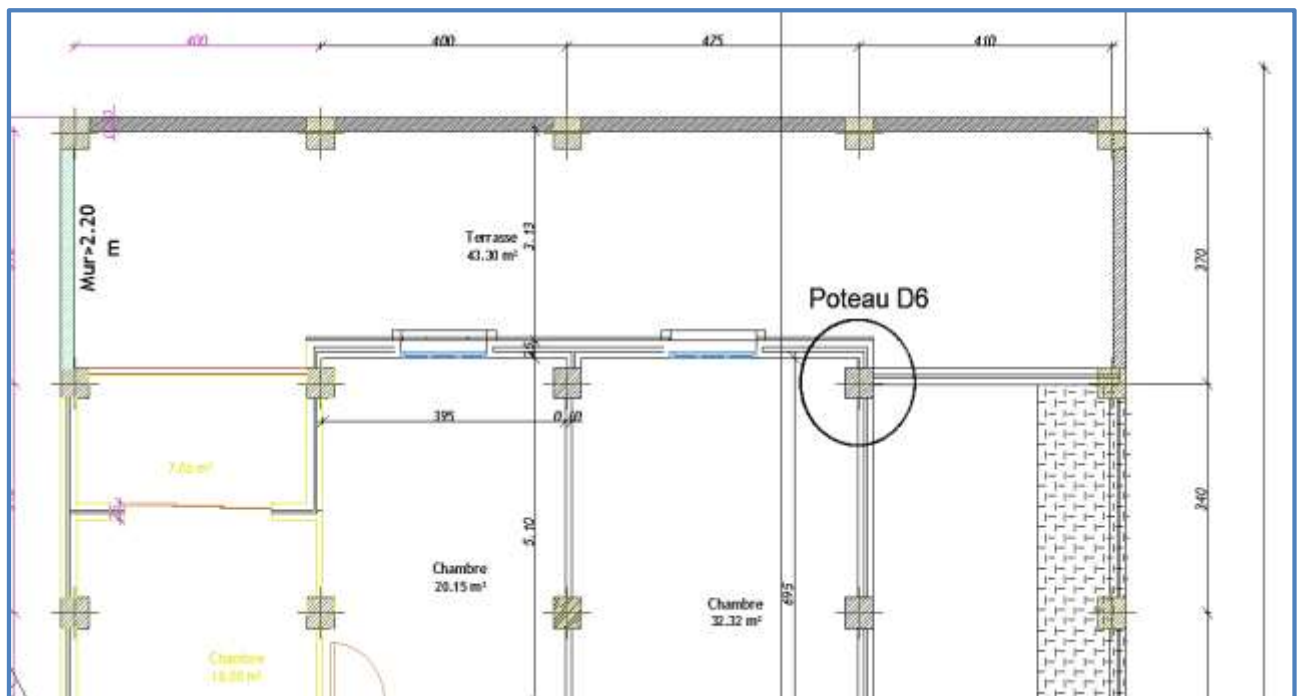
Position sur le plan du poteau le plus sollicité : axes (x4 ; y6)
